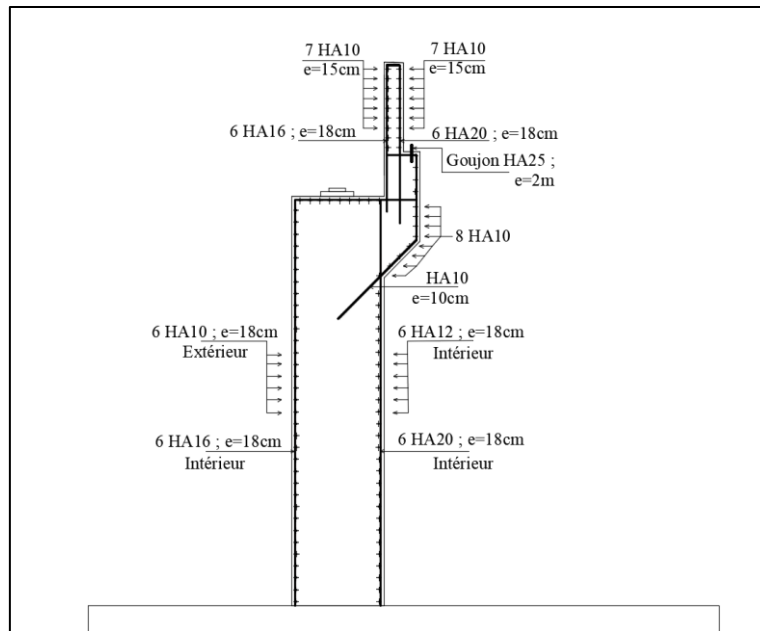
Ferrailage du mur de fond, mur garde grève et corbeau
